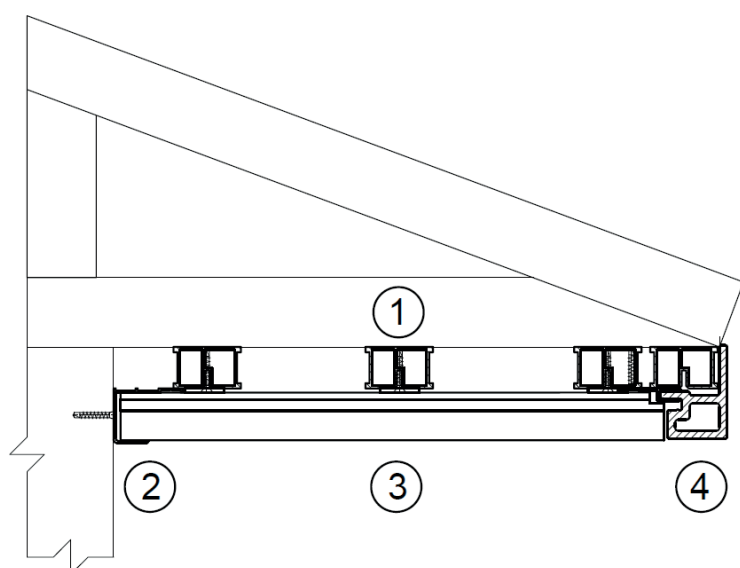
Revestimiento de voladizos de cubierta con perfiles de fachada FS 21
